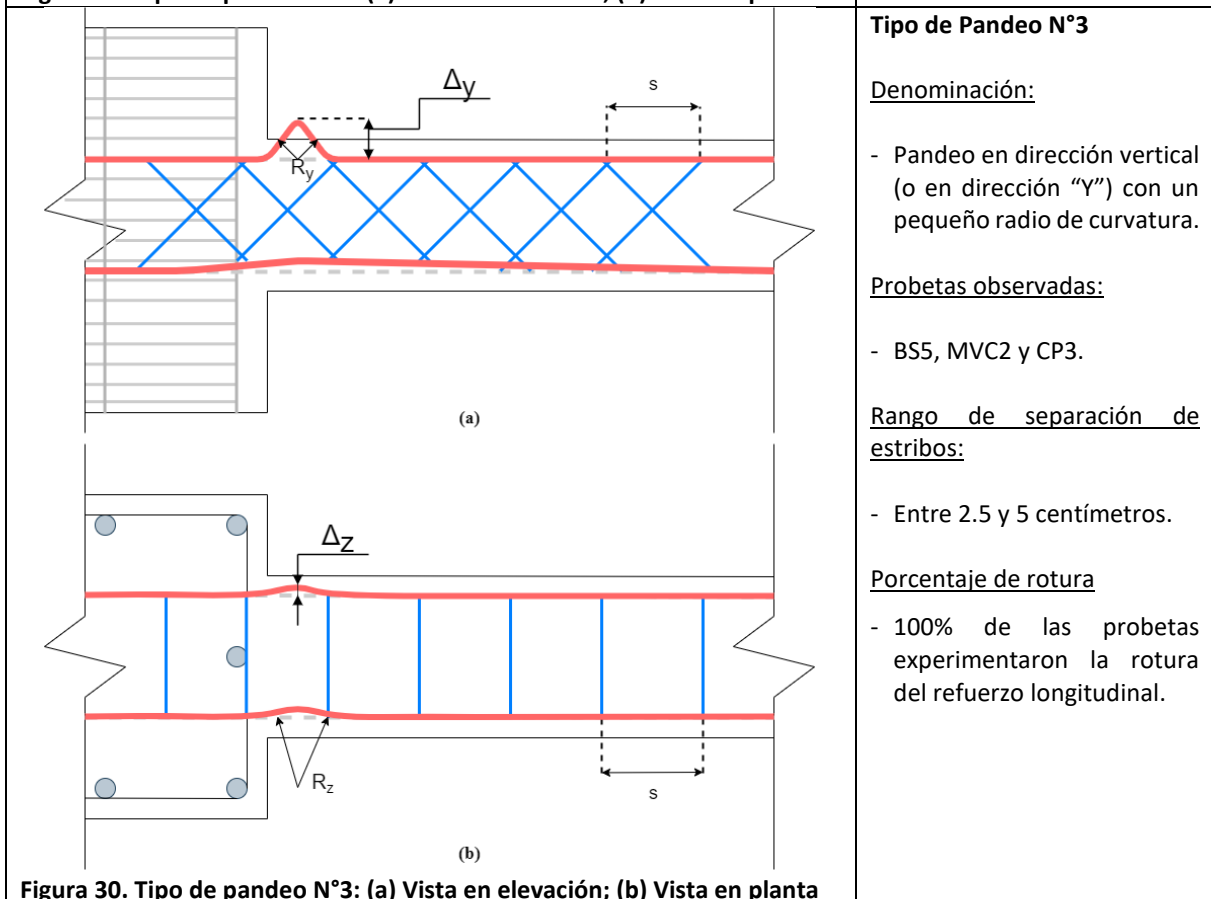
Tipo de pandeo N°3: (a) Vista en elevación; (b) Vista en planta
